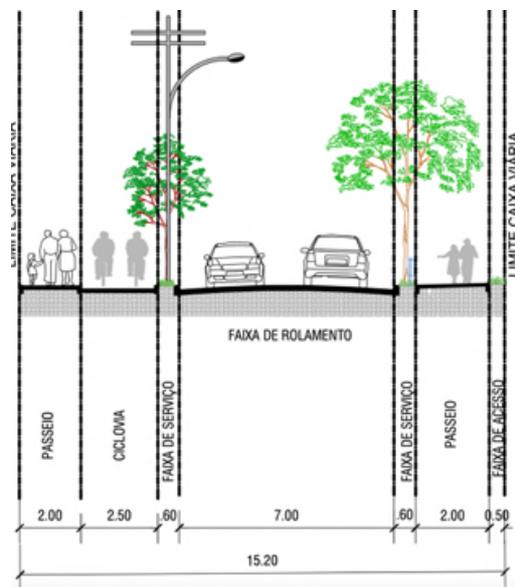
Via de Circulação de Vizinhança 1 – Rua Parque Tangará. Fonte: MDE EP
